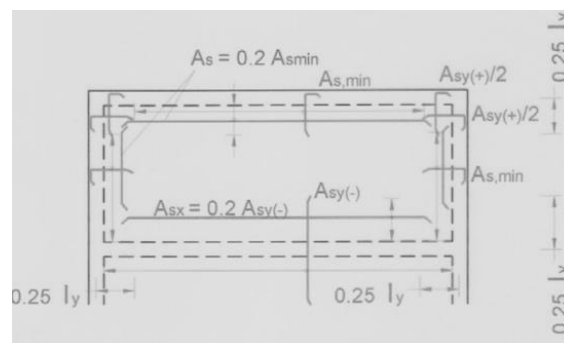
Armadura superior numa laje apoiada em três bordos e contínua no outro ($l_x \geq 2l_y$)- vista em planta
